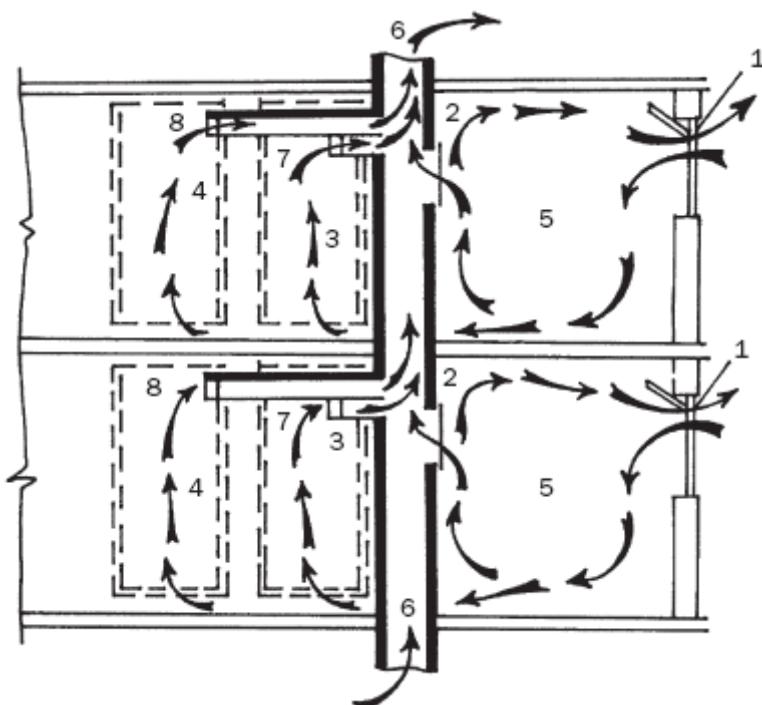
Движение воздуха в системе «кухня – ванна – туалет»: 1 – форточка; 2 – вентиляционное окно стояка; 3 – туалет; 4 – ванная комната; 5 – кухня; 6 – вентиляционный стояк; 7 – вентиляционное окно туалета; 8 – вентиляционное окно в ванной комнате
